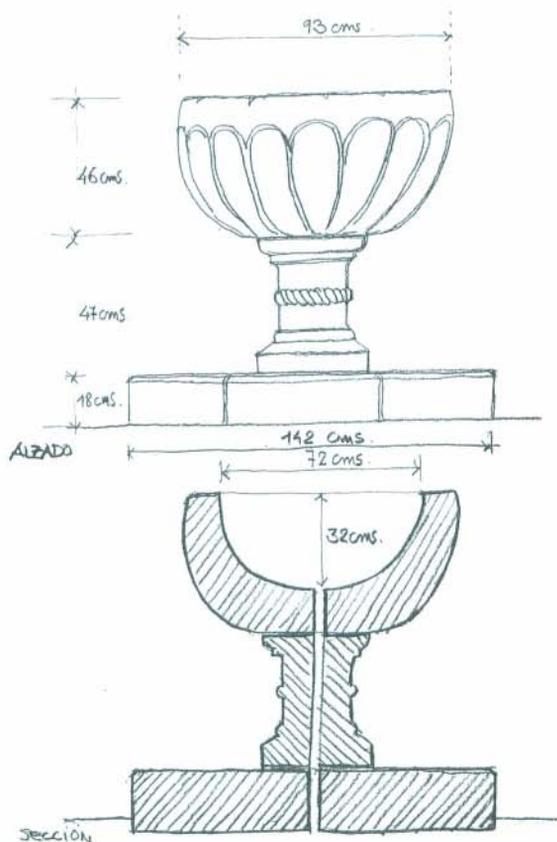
Alzado, sección y medidas de la pila bautismal. (Antonio Peiró).
